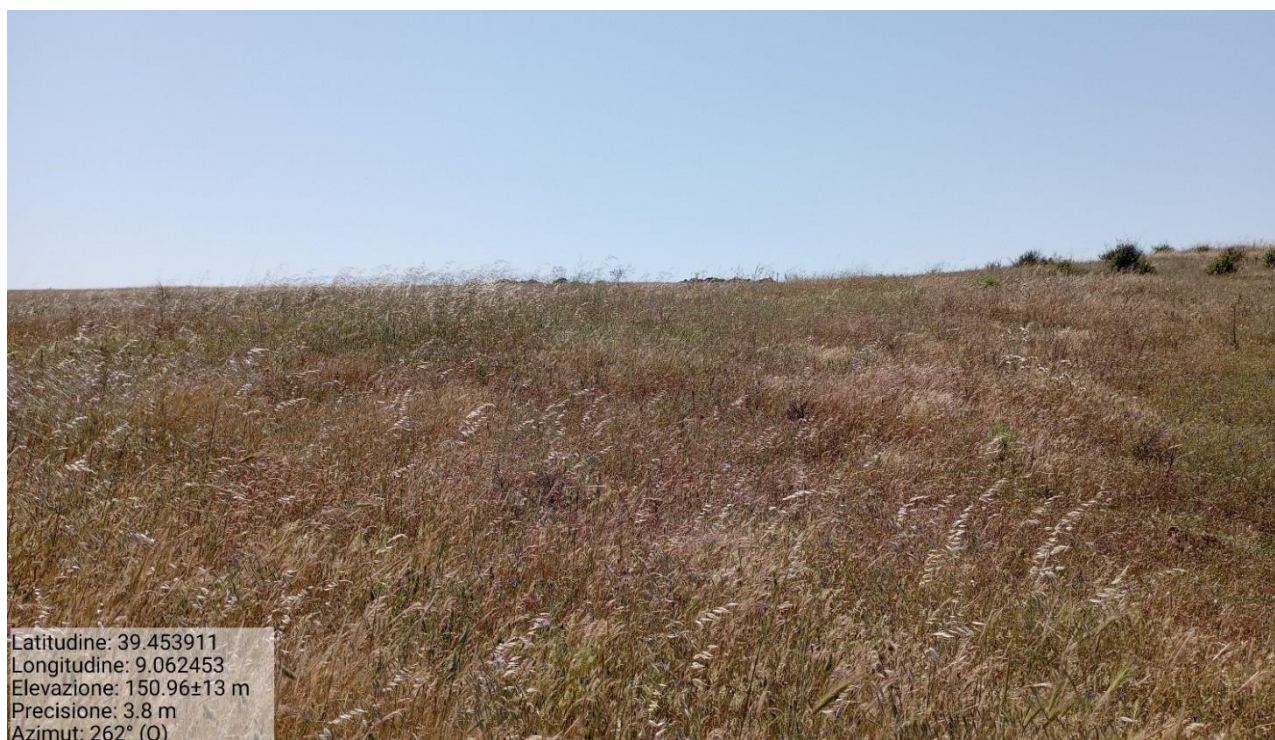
Terreno attraversato dalla viabilità di nuova realizzazione di accesso alla postazione WTG05 (direzione ovest).
